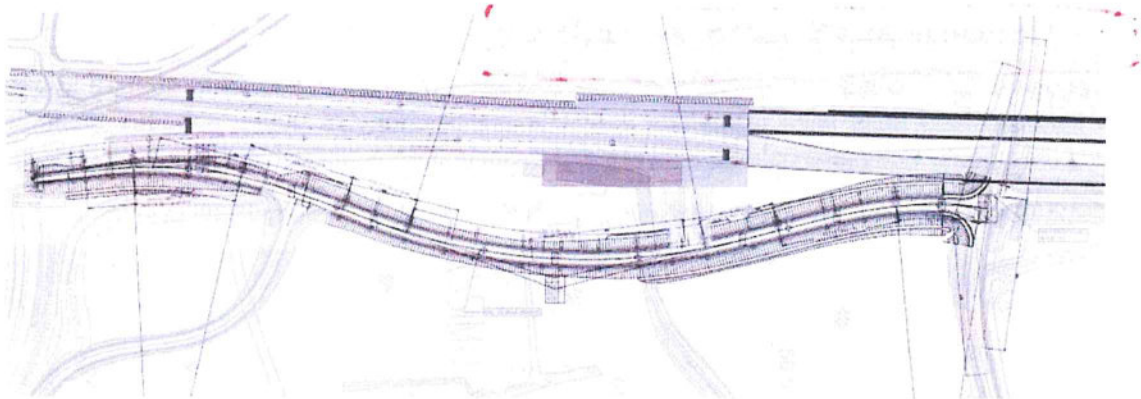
Stralcio planimetrico su rilievo Via della Spianà definitiva
